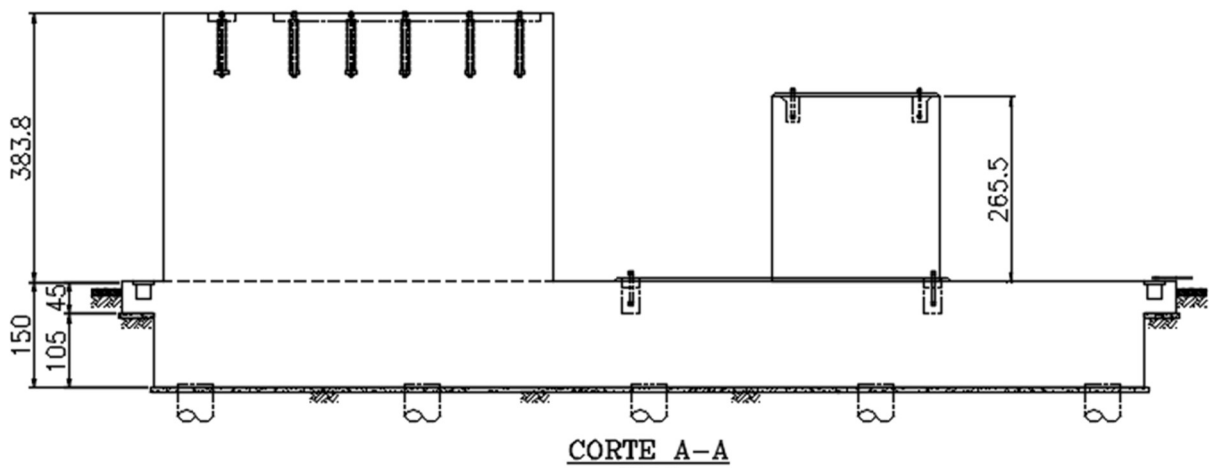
Modelo estrutural: elevação da fundação (Corte A-A)
